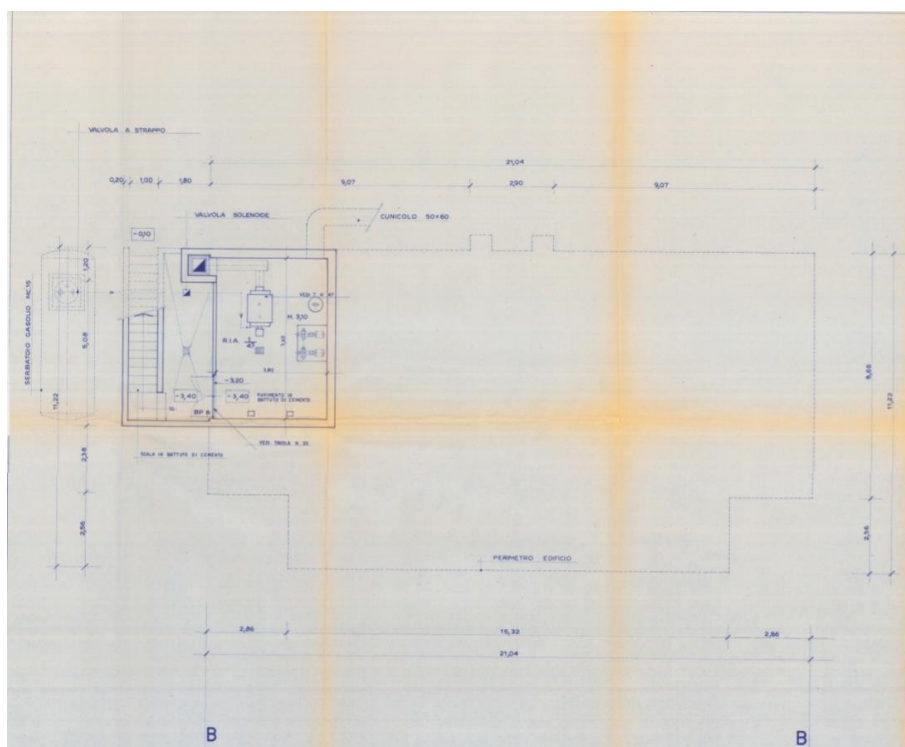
, Pianta locale caldaia, scansione progetto originale
